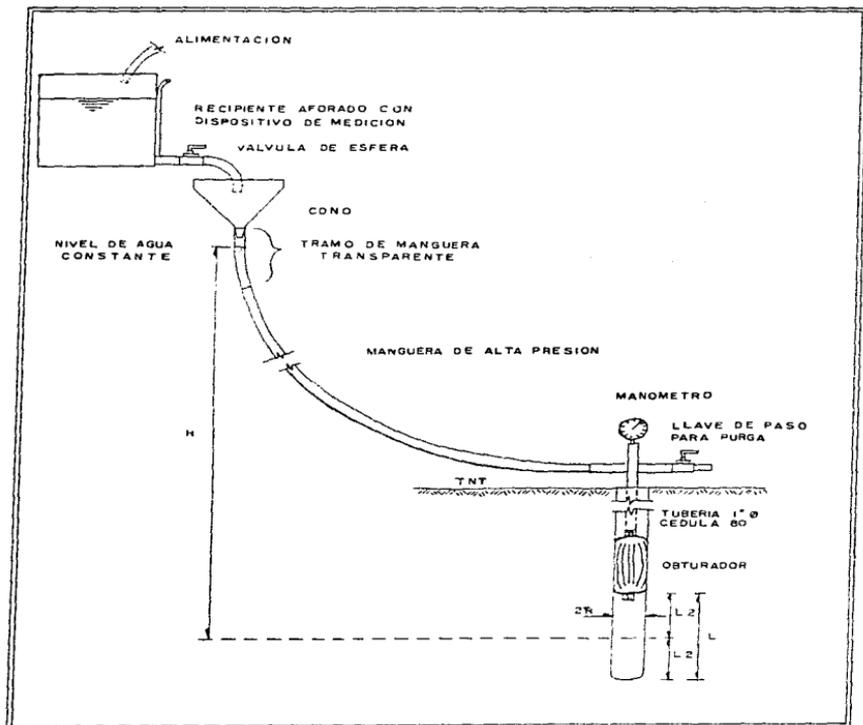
Equipamiento del barreno y equipo de inyección para la prueba Lugeón.
